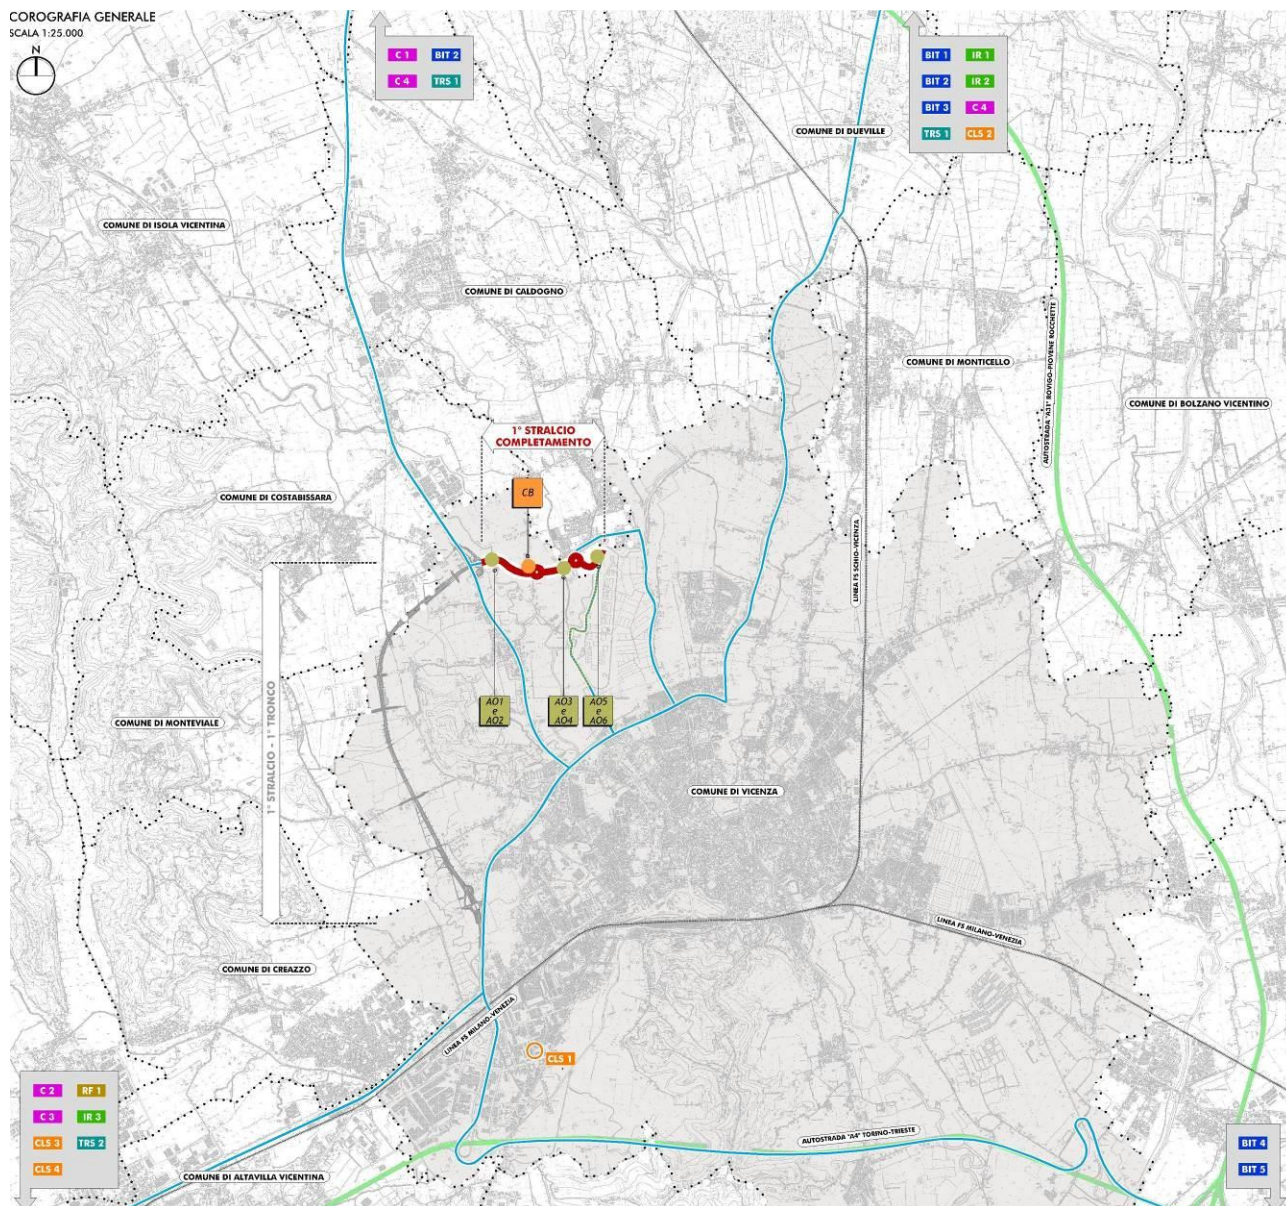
PLANIMETRIA CON INDICAZIONE DEI POLI DI CONFERIMENTO/FORNITURA (ESTRATTO DALL'ELAB. T00CA01CANCO01)
